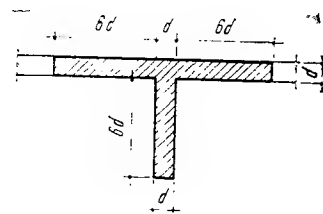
Secțiunea convențională de armare a pereților din beton armat monolit.
